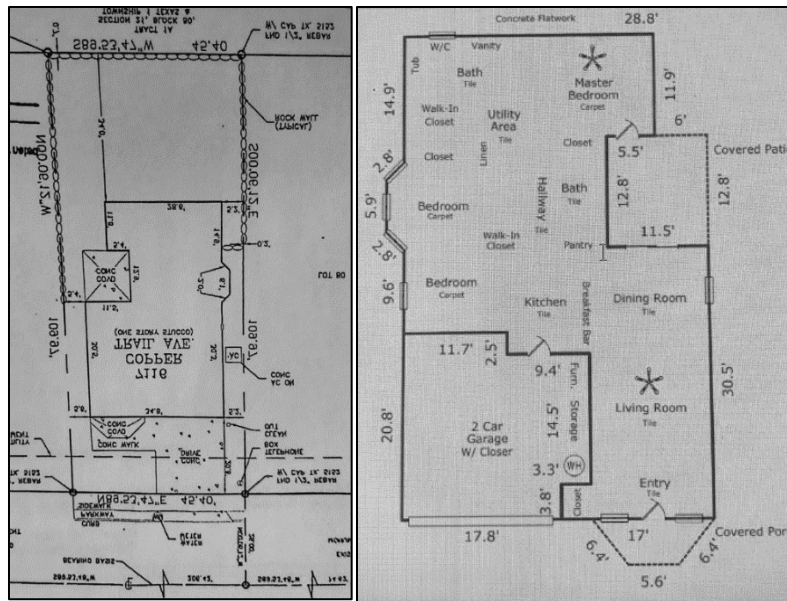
Plantas arquitectónicas de la vivienda.⁸⁹
